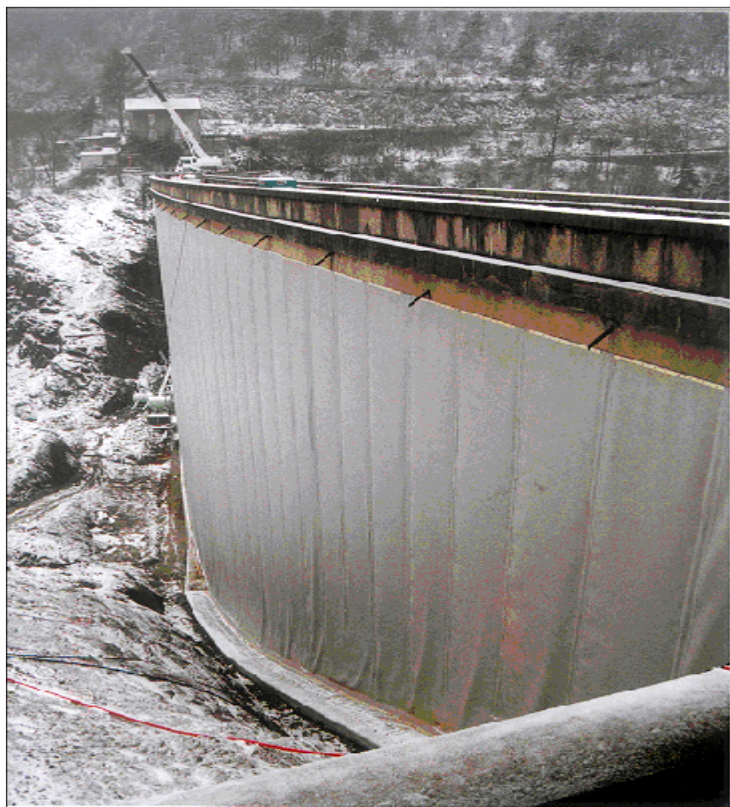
Barrage de l'Echapre vue d'ensemble du parement amont.
